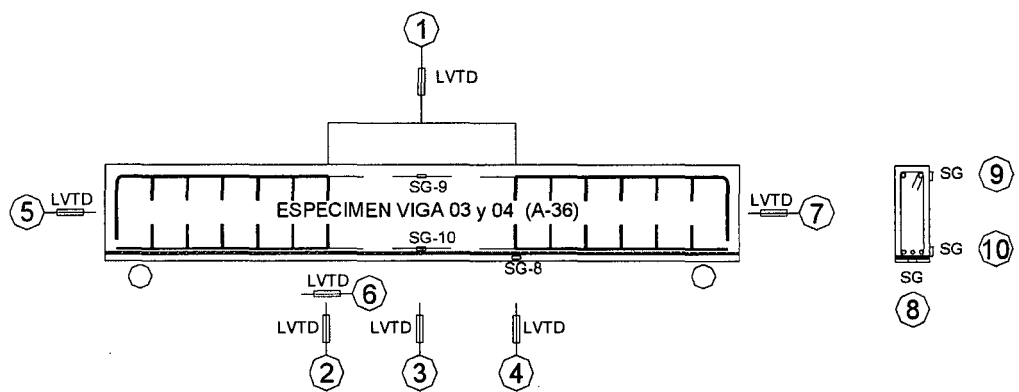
Ubicación de Transducer y Strain Gage en los espécimenes Viga 03 y 04 reforzadas con platinas de acero A36
